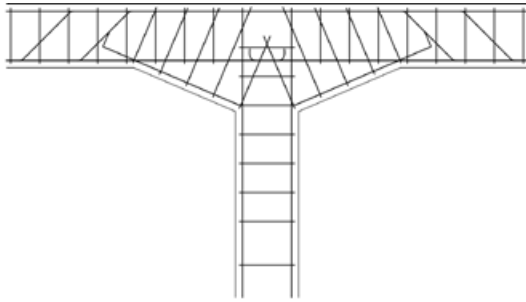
Bewehrungsführung über einer Binnenstütze nach Mörsch (Umzeichnung: JR).
